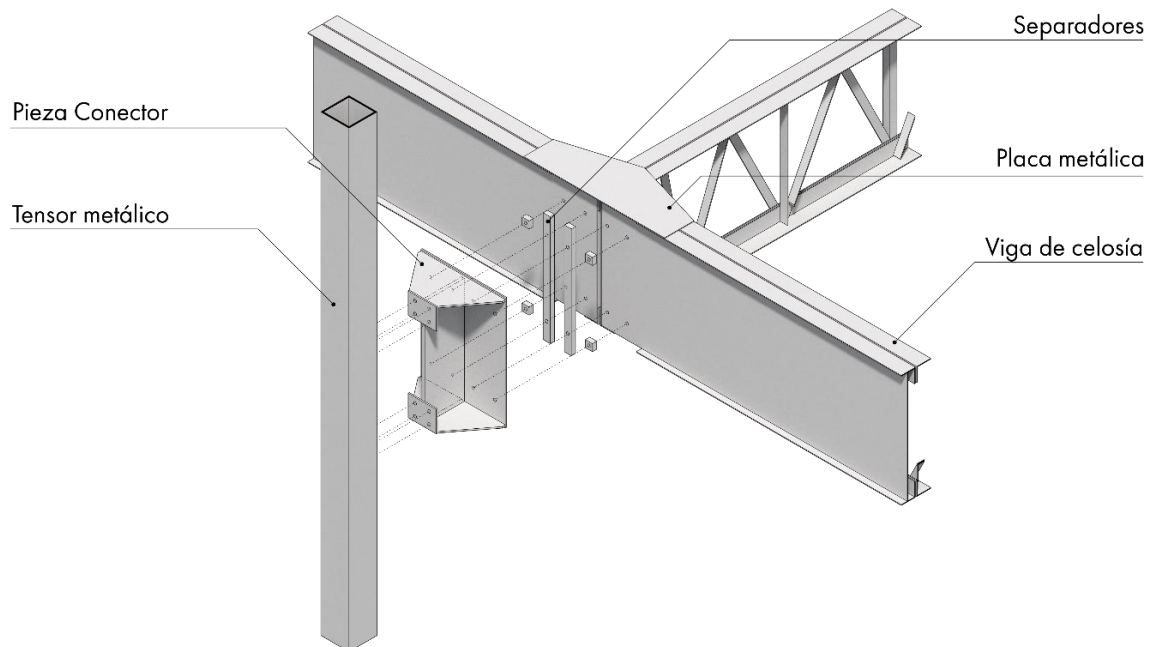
Detalle. Encuentro tensor – vigas. Elaboración propia.
